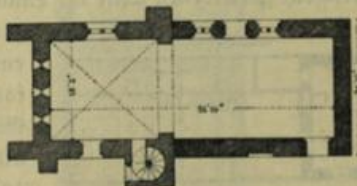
Wusterhausen. Heiliggeistkapelle. Grundriß.
